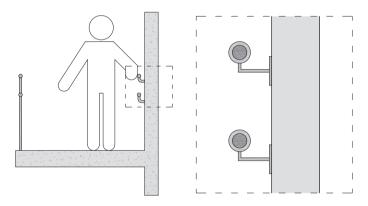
Detalle de altura de colocación y sección transversal del pasamanos.
